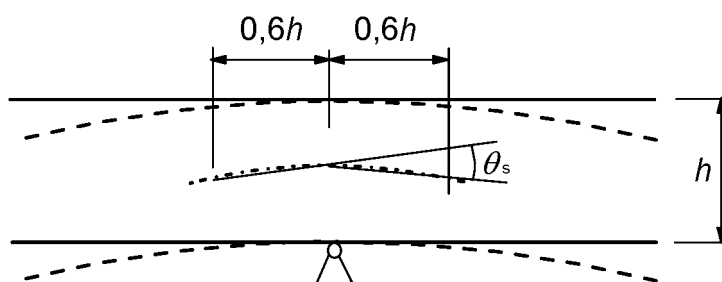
Giro plástico θ_s de las secciones de hormigón armado para vigas continuas y losas continuas unidireccionales
